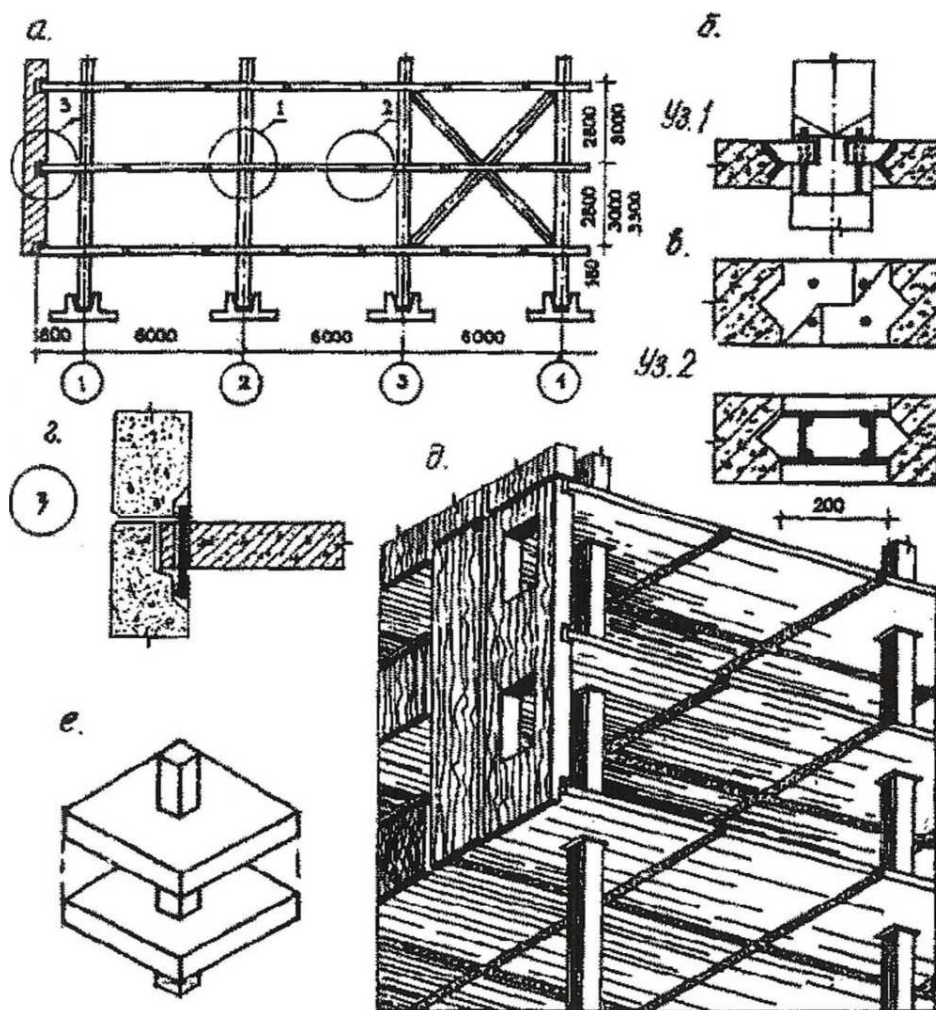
Конструкція багатоповерхової будівлі конструктивної системи "КУБ", варіант КУБ-2 а - принципова схема каркасу; б - вузол сполучення колони з надколонною плитою; в - стик (шов) сполучення надколонної плити з проміжними плитами; г - стик сполучення крайки плити з зовнішньою стіною;
